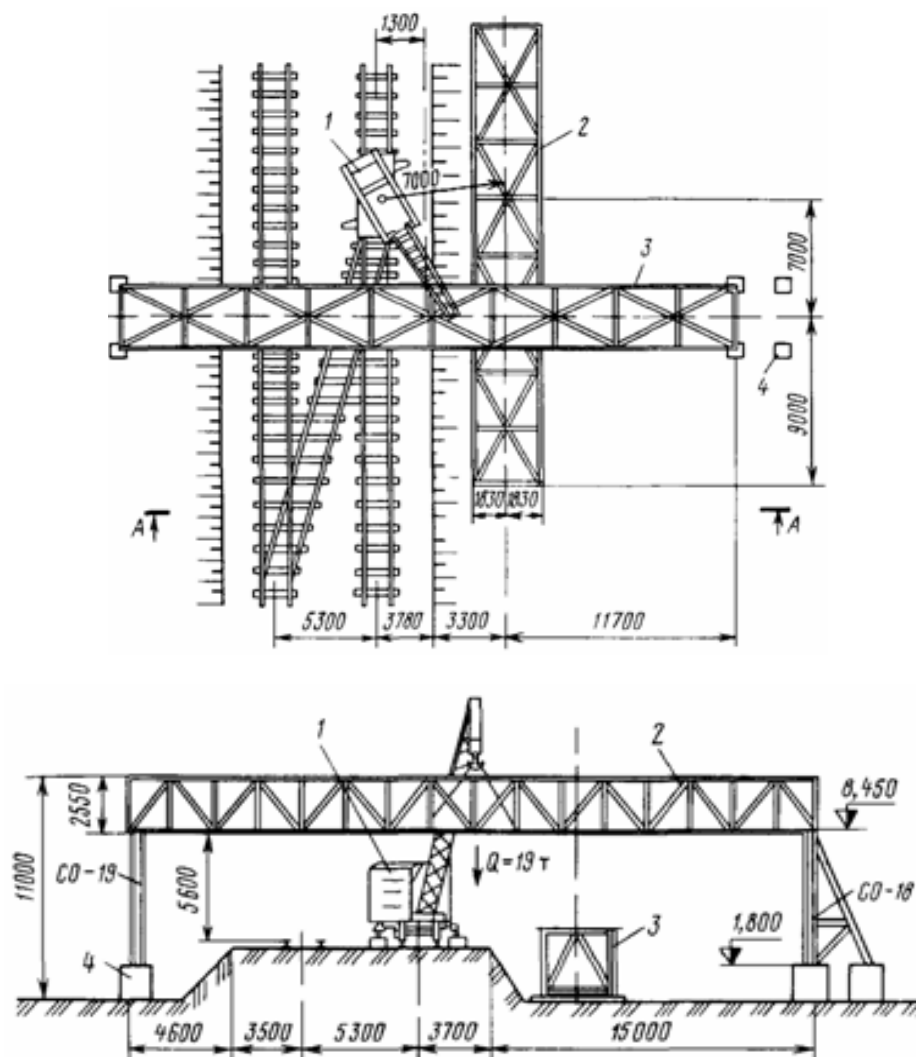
Монтаж пролетного строения транспортной галереи одним краном: 1 – монтажный кран, 2 – положение пролета перед подъемом, 3 – монтаж пролета, 4 – опоры.
